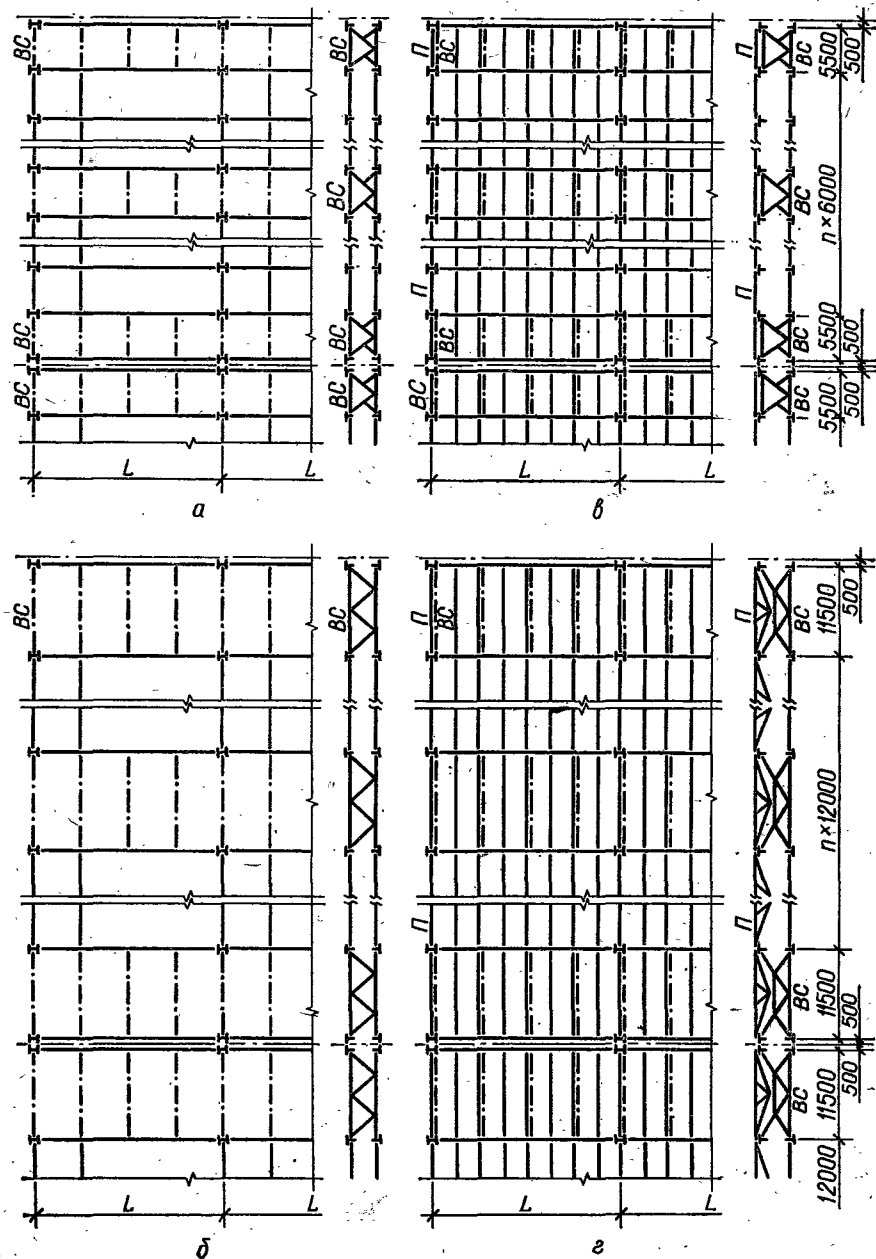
Схемы расположения элементов покрытия в уровне верхних поясов ферм при применении:
